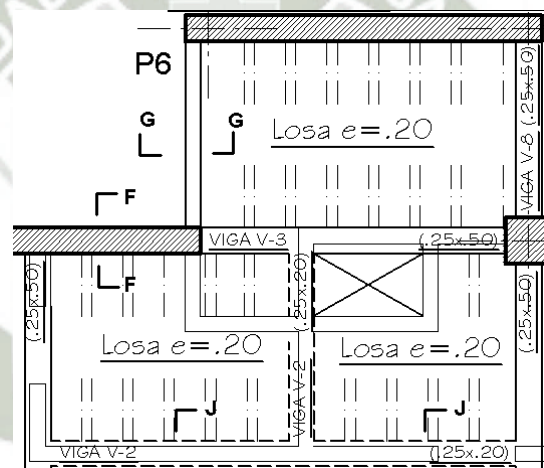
Losa aligerada de baño y lavandería primer bloque
